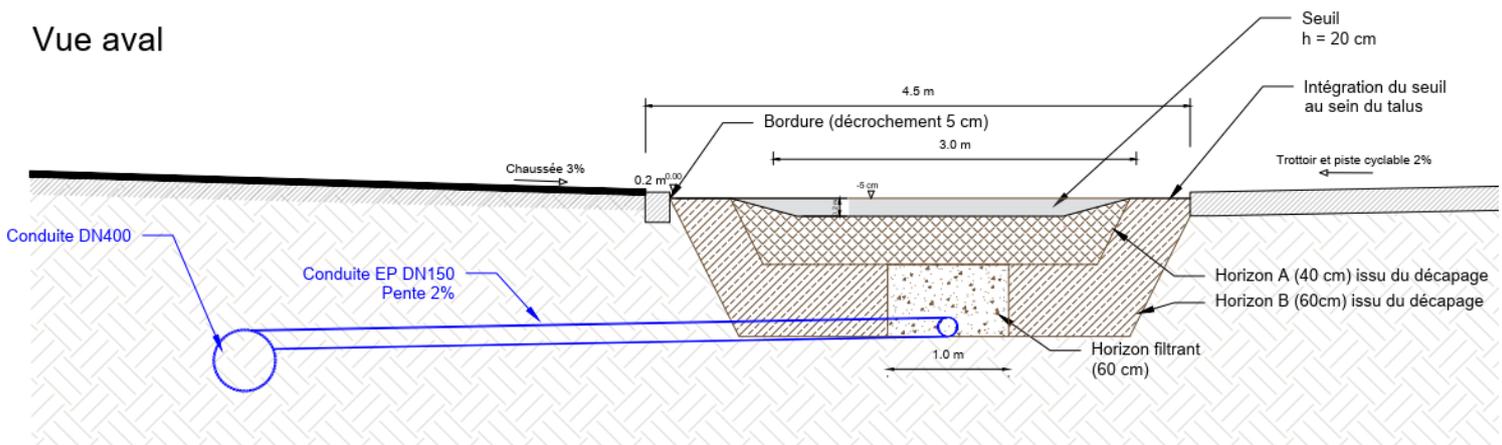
Schéma de fonctionnement hydraulique du système de gestion des eaux de chaussée - Profil en travers d'un filtre
